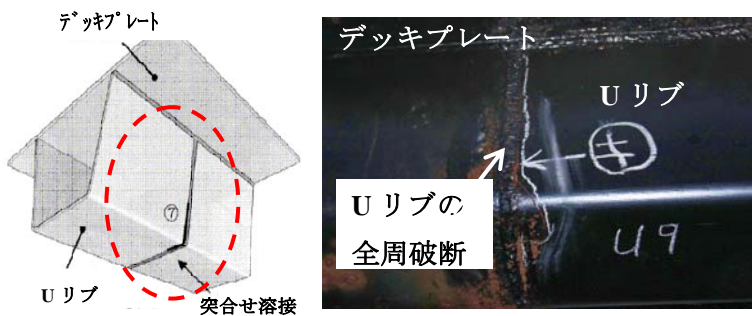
Uリブ突き合わせ溶接部の損傷状況
